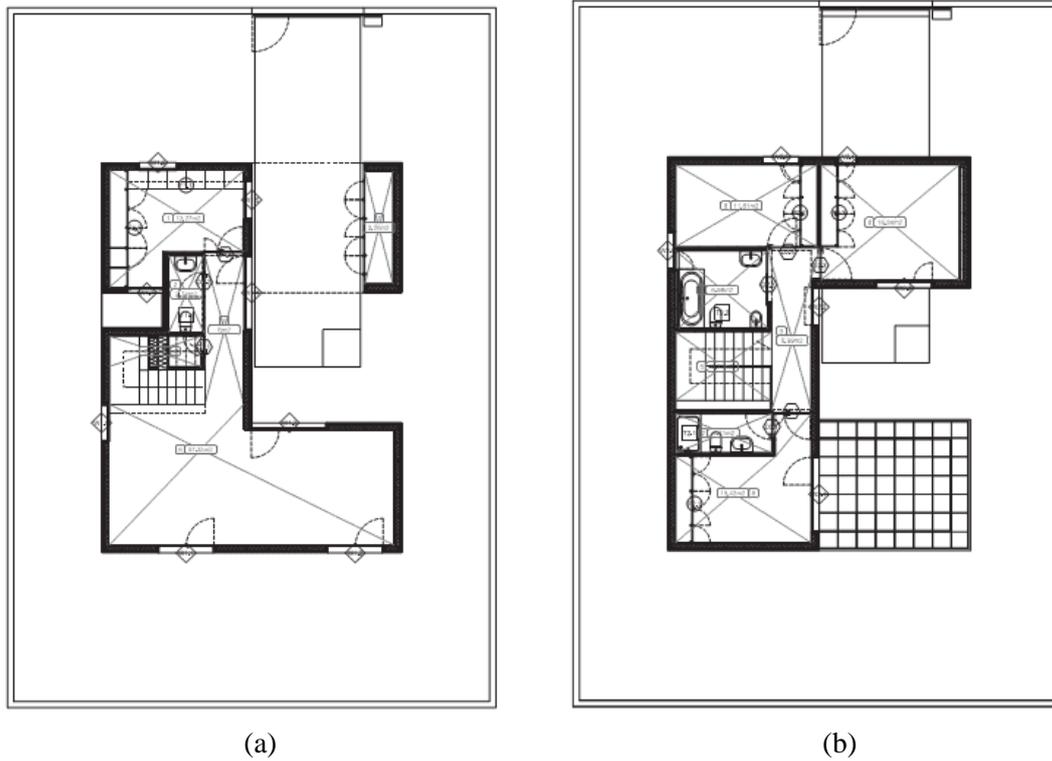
Planta de arquitetura. a) Planta do piso 0; b) Planta do piso 1 (Fonte:)
